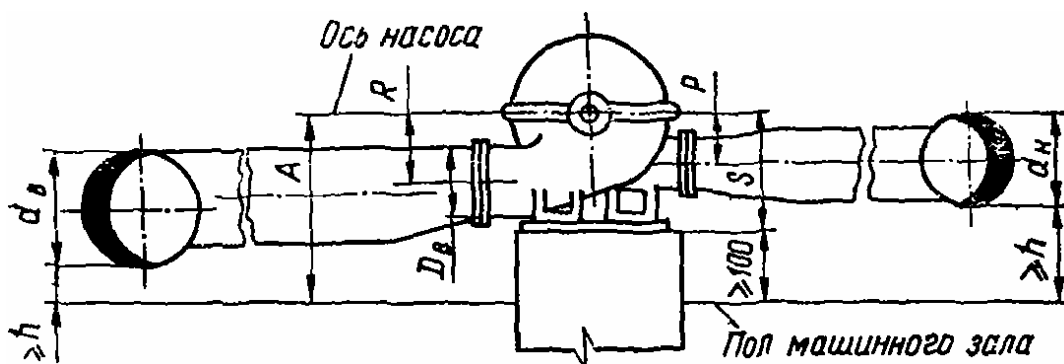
Схема к определению возвышения фундамента насоса над полом
